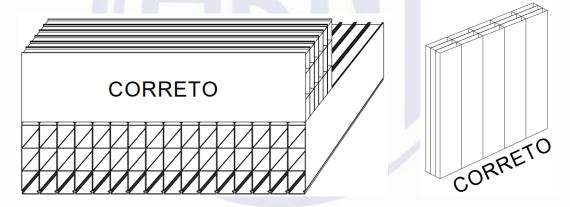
Forma correta de armazenamento dos painéis de PVC
